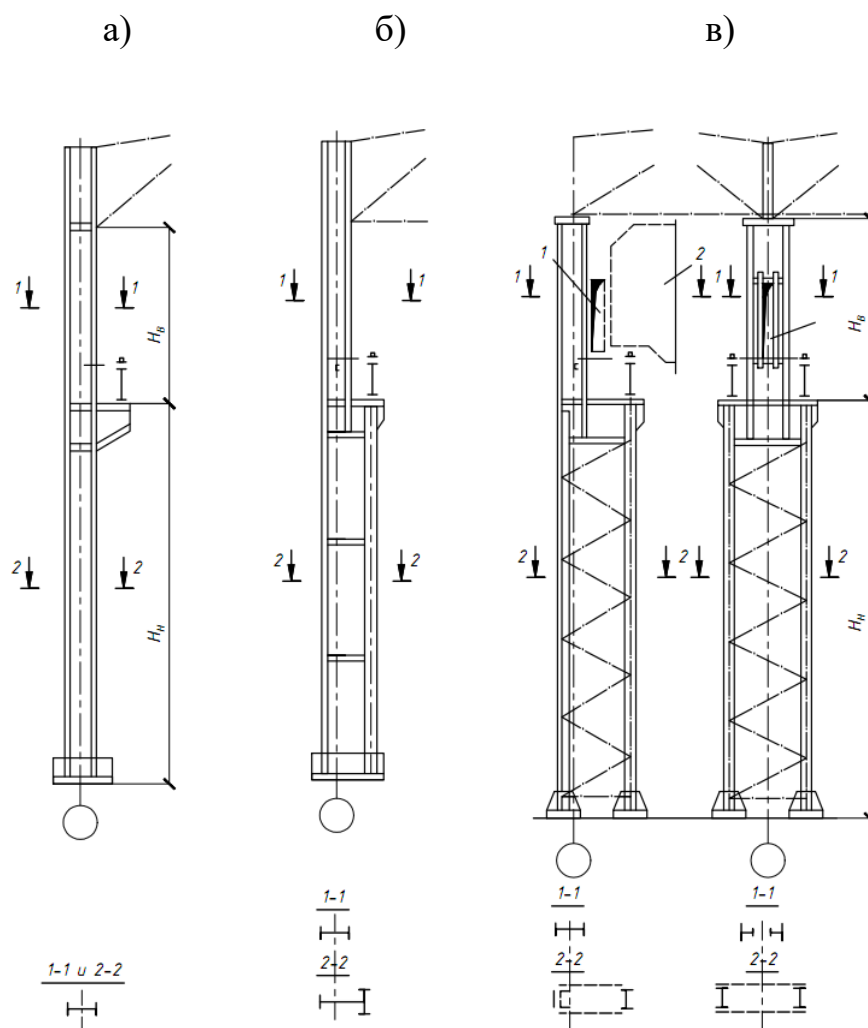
Стальной каркас здания сборочного цеха
